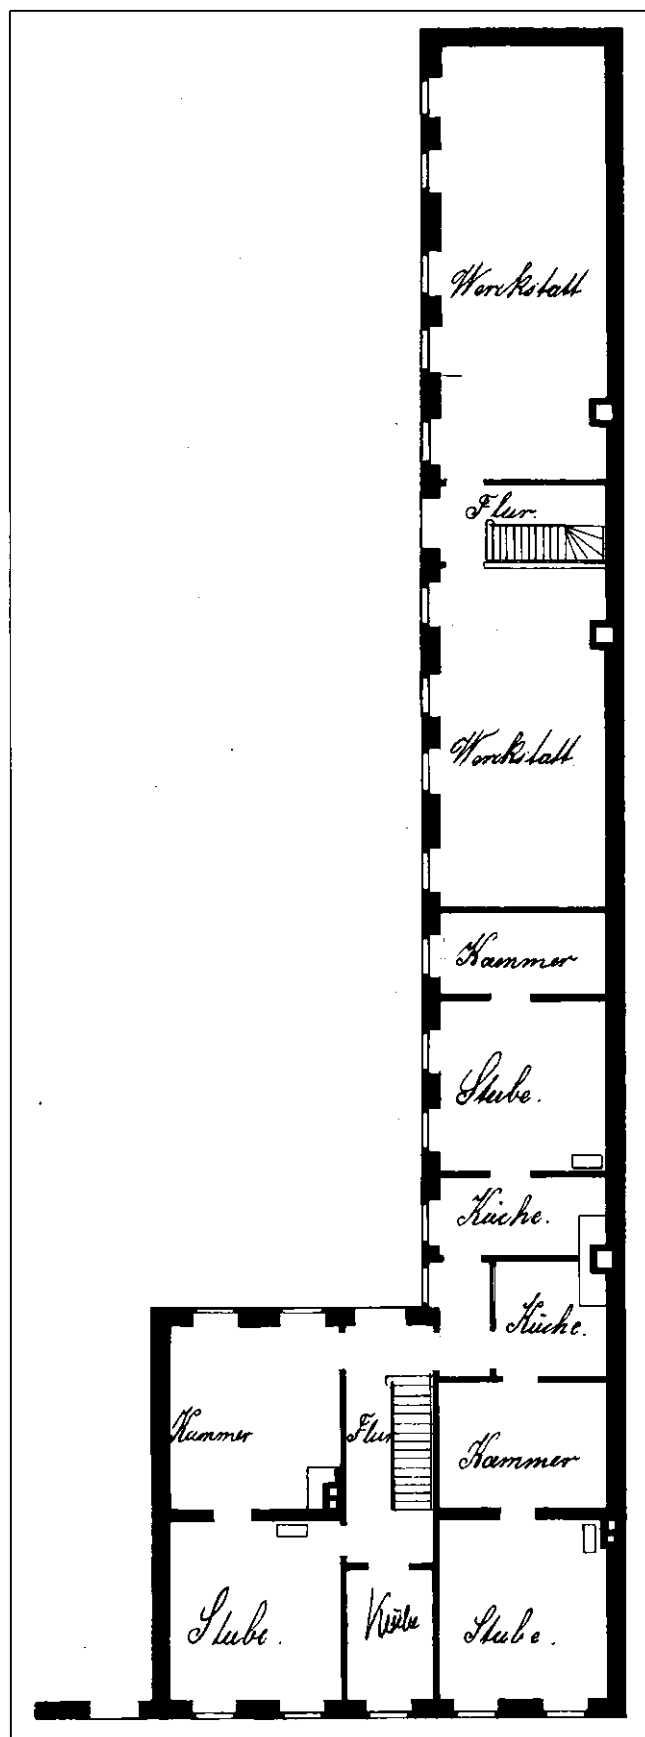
1869, Grundriß des Wohngebäudes Liebermannstraße 11b
